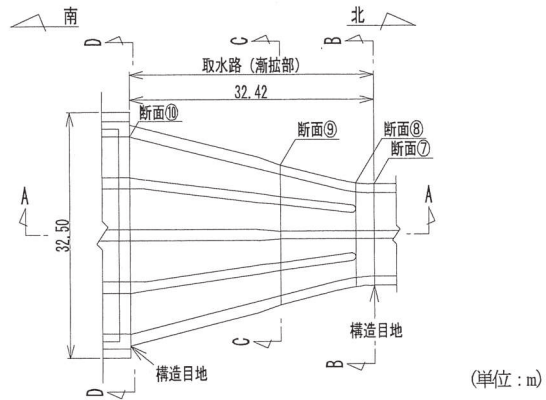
取水路 (漸拡部) 平面図及び候補断面位置
